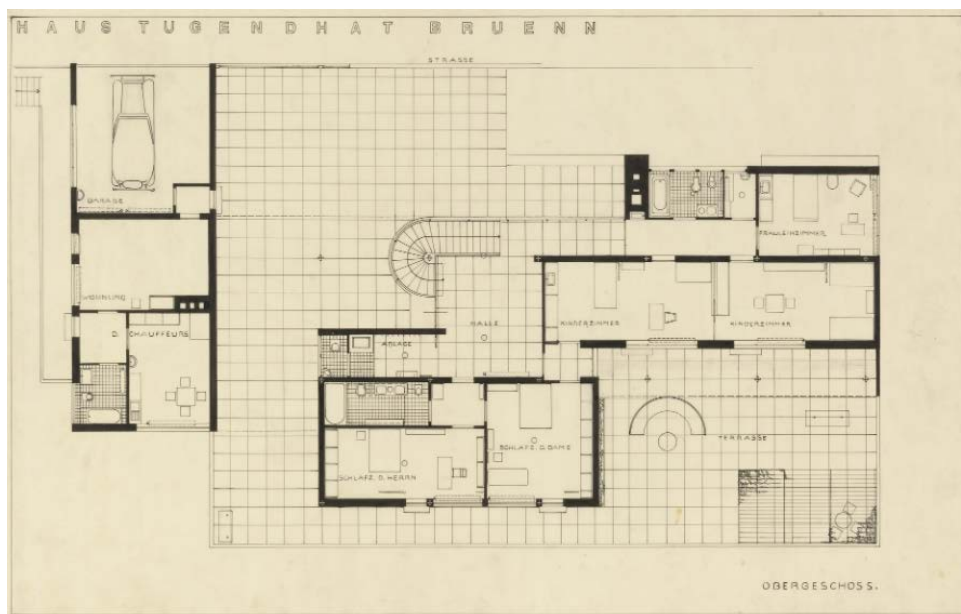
Planta baixa do nível de acesso, Casa Tugendhat, 1930.
